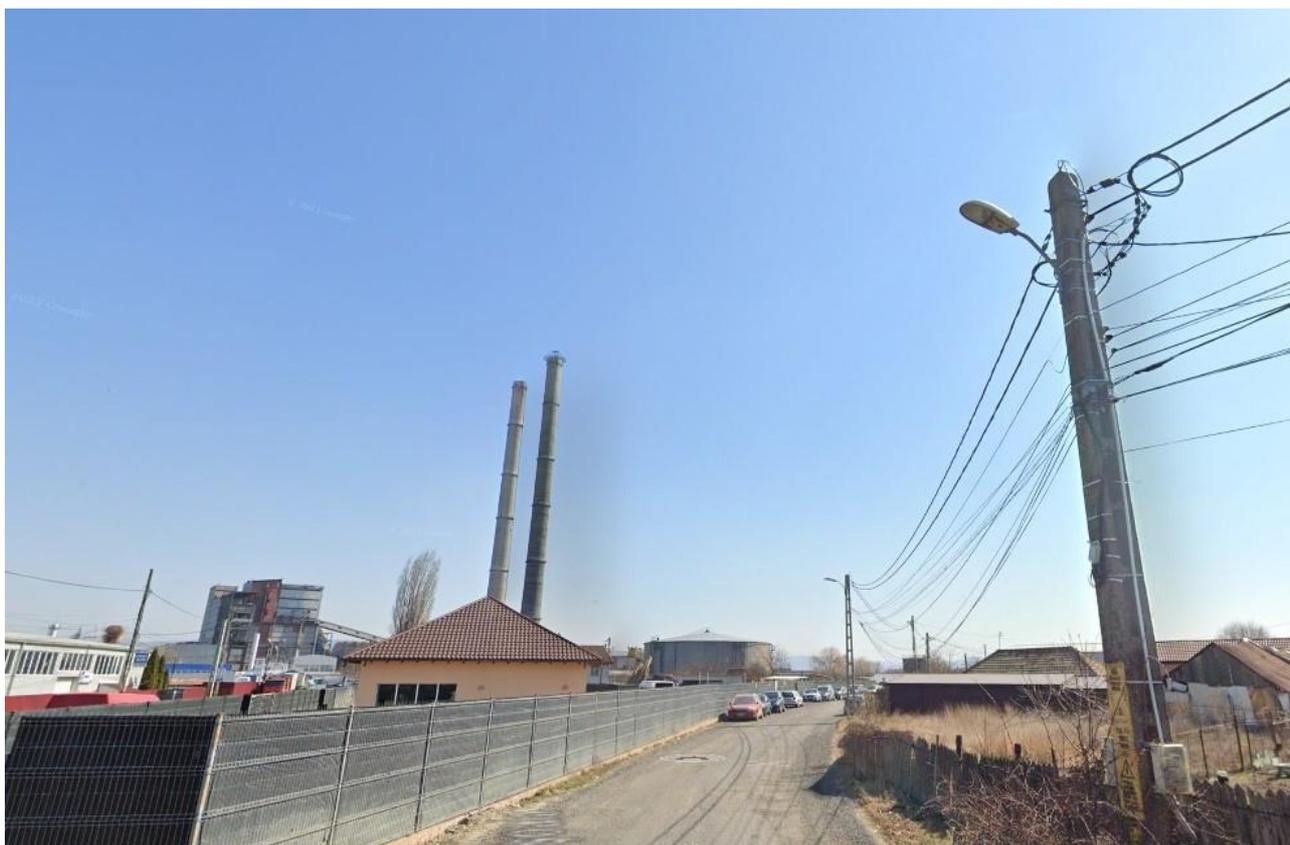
Amplasament existent Strada Ciresoia Tr. 1
